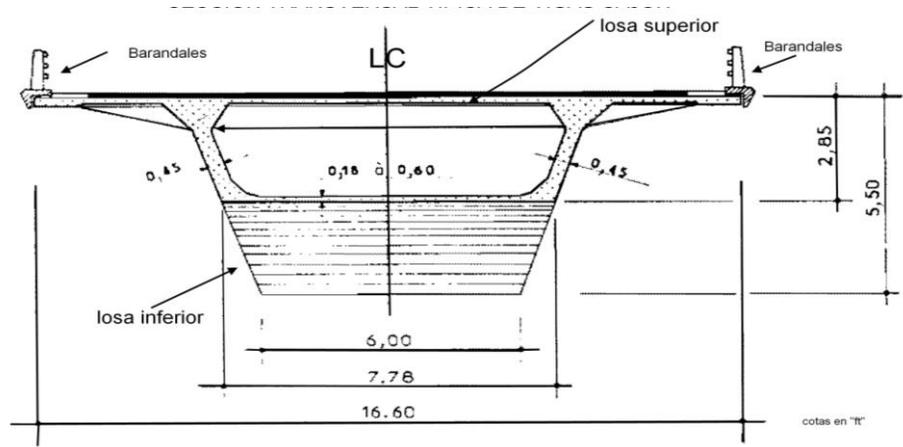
Sección transversal del puente Saint André de Cubzac
